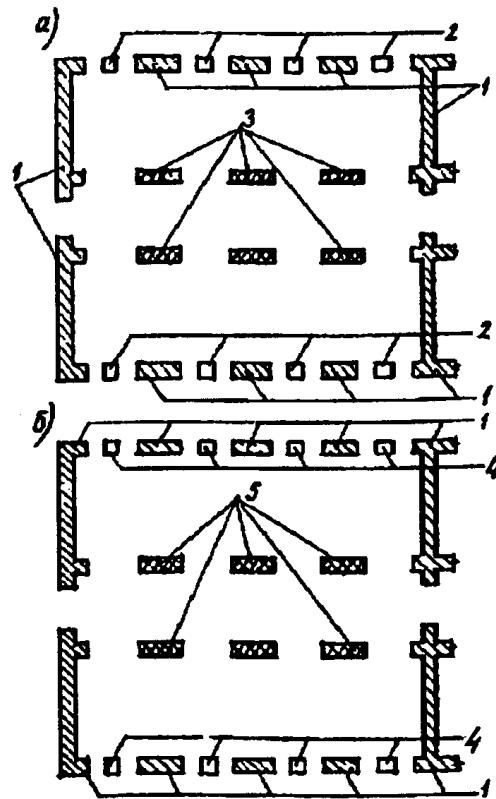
Фрагмент плана первого этажа четырехэтажной кухни-столовой (*а* — по плану; *б* — возможное решение при применении одной марки кирпича и одной марки раствора):
